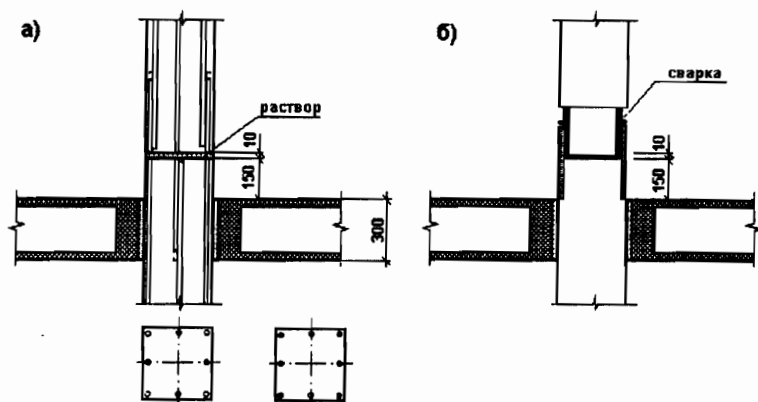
Стыки колонн для возведения многоэтажных жилых (а) и промышленных (б) зданий
